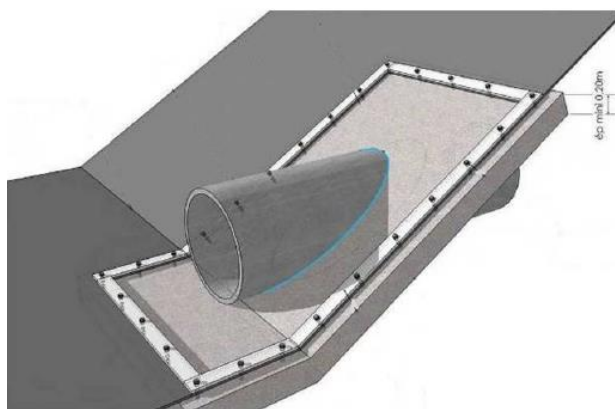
Exemples de raccordement sur massif béton (source : Fascicule 10 du CFG)
